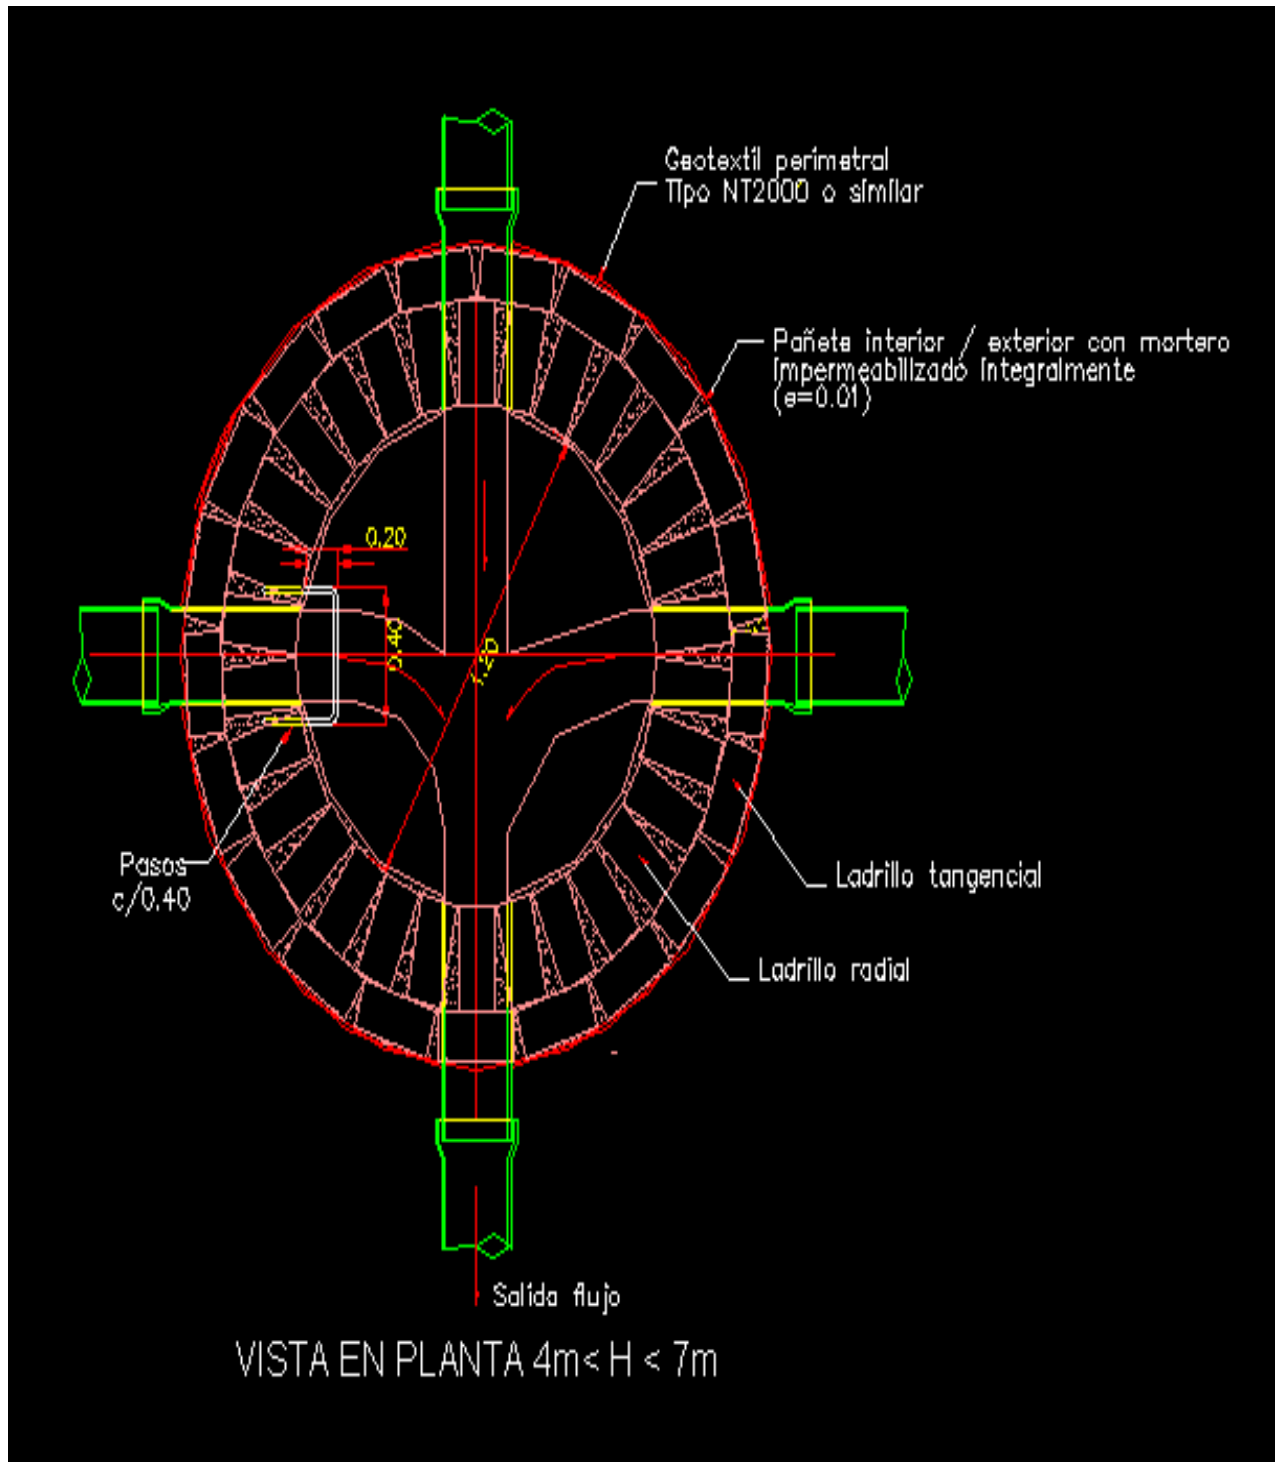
Planta de Pozos de inspección alturas entre 4 y 7 metros
